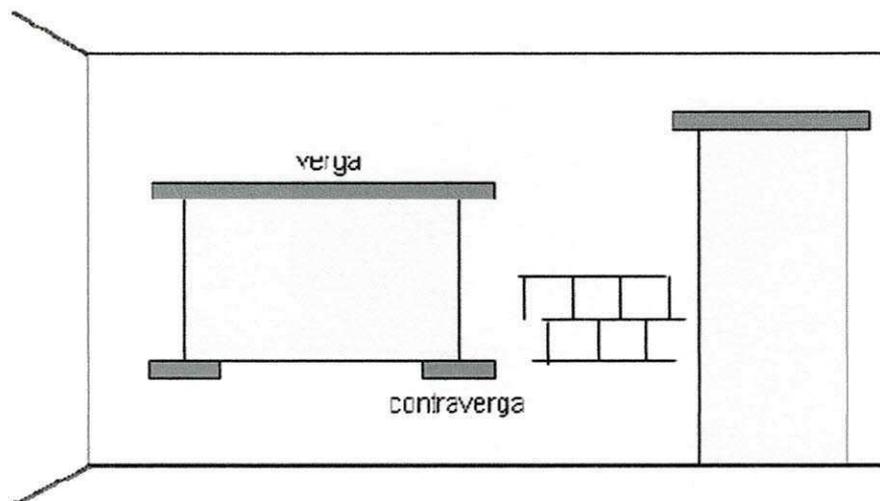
Vergas e contravergas em vãos de portas e janelas.
